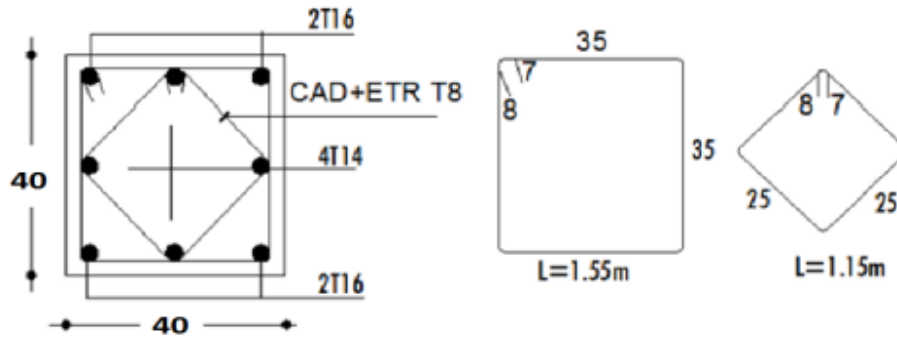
Coupe du ferrailage des poteaux 35x35
